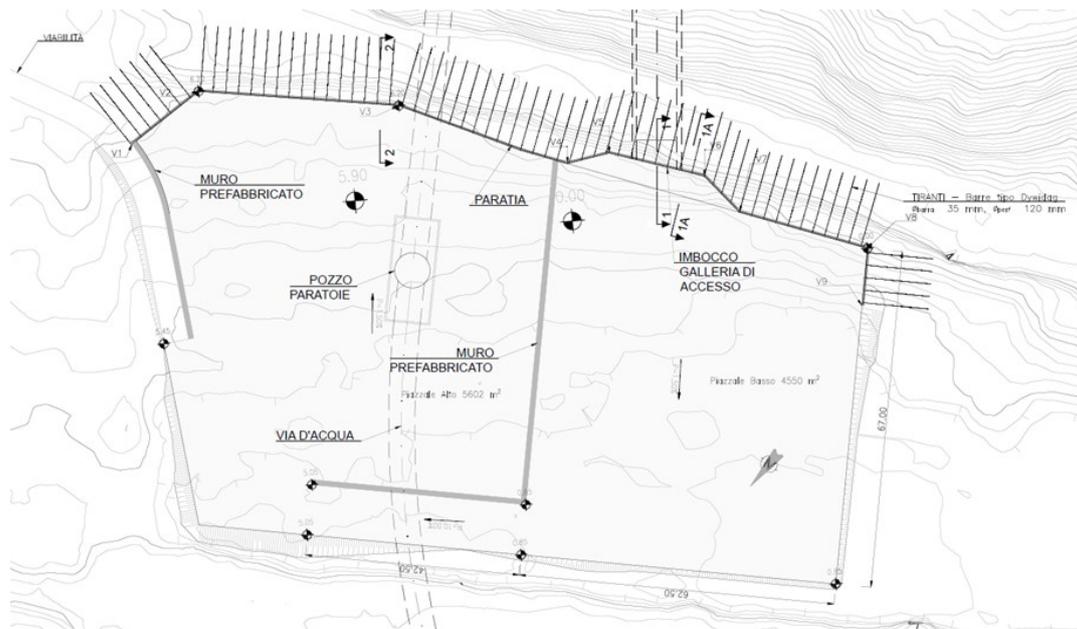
Planimetria del piazzale di cantiere e paratia al piede della S.S. 18
